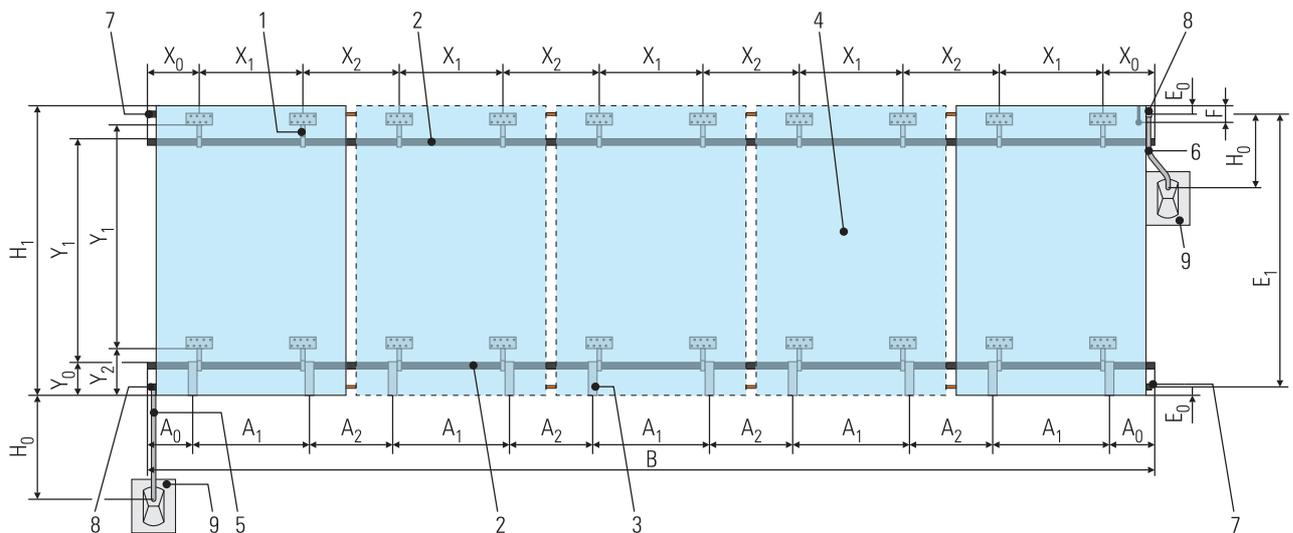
Dimensione principale di un campo solare dei collettori per il montaggio su tetto (in figura, collettore EKSV26P)
